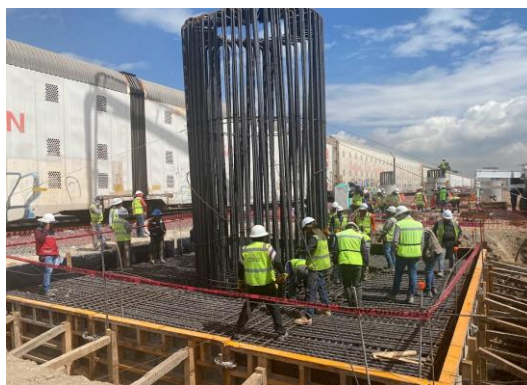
y 106 Autoría Propia (2023) "Trabajos de colocación de cimbra para zapatas de Apoyos Intermedios"
